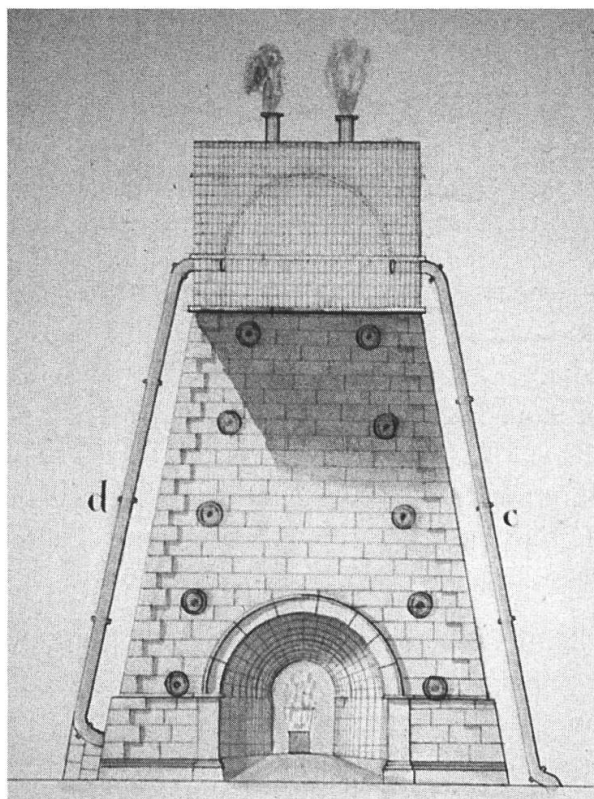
Haut fourneau de Varigney – Plan en élévation de la tour du haut fourneau surmontée d’un système de récupération de l’air chaud du gueulard. C conduite de l’air froid au four. D autre conduite portant l’air chaud à la tuyère. ADHS 301 S 5. Un système similaire a certainement été mis en place à Montagney. (Photographie : Denis Morin).
